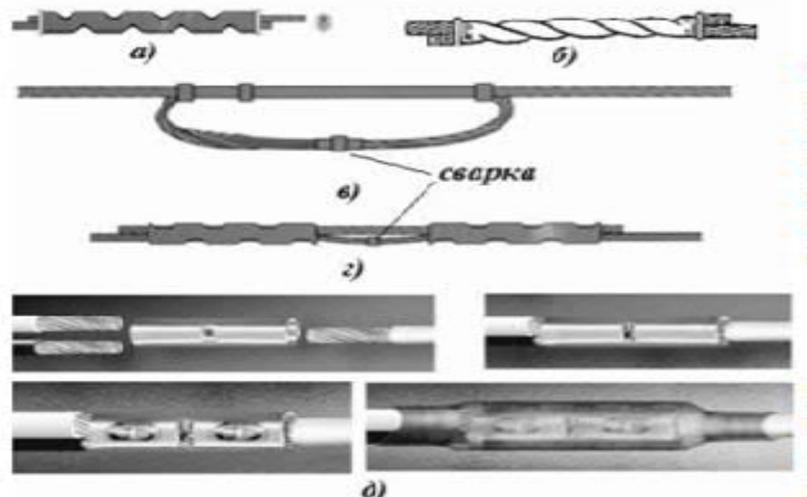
Соединение проводов: а-б) – обжатие и скручивание неизолированных проводов; в-г) – обжатие со сваркой; д) – соединение трех изолированных проводов обжатием
